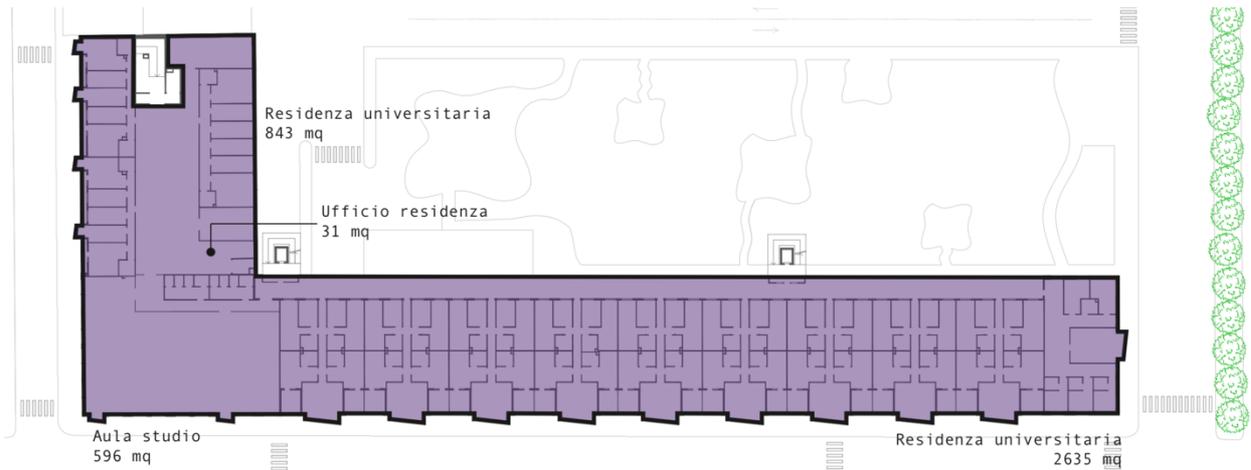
Distribuzione al secondo piano. Pianta non in scala. Estratto da tavola 4.
